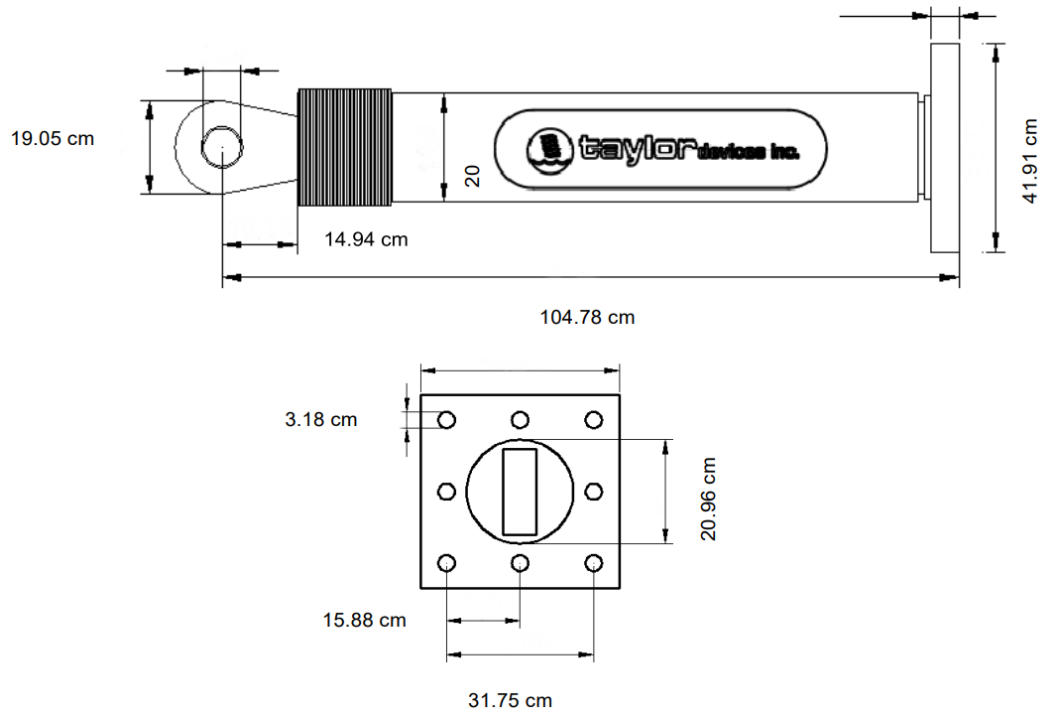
Dimensiones de disipador y placa base de 220 Kip.
